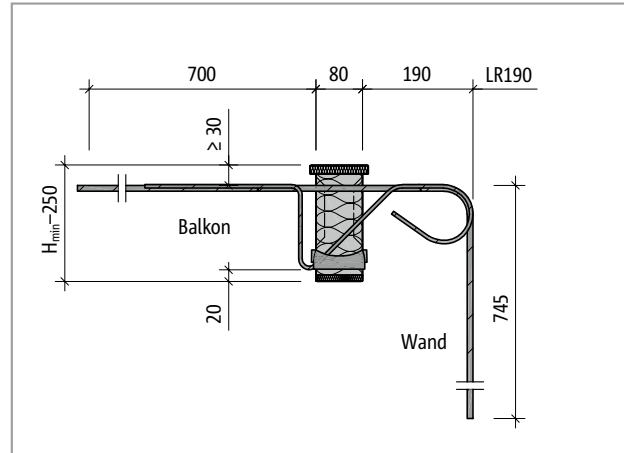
Schöck Isokorb® T Typ K-WU-M2: Produktschnitt
